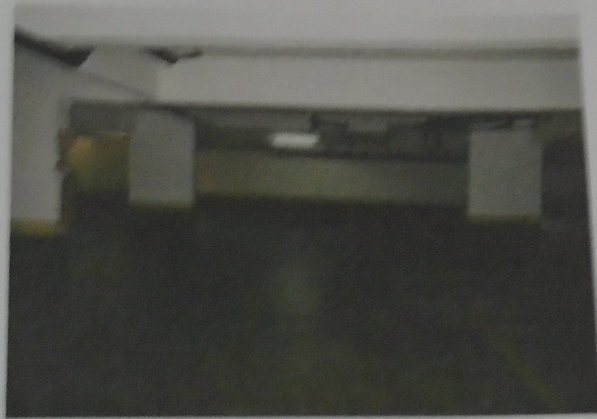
Garagem - Vista Geral - 1º subsolo
